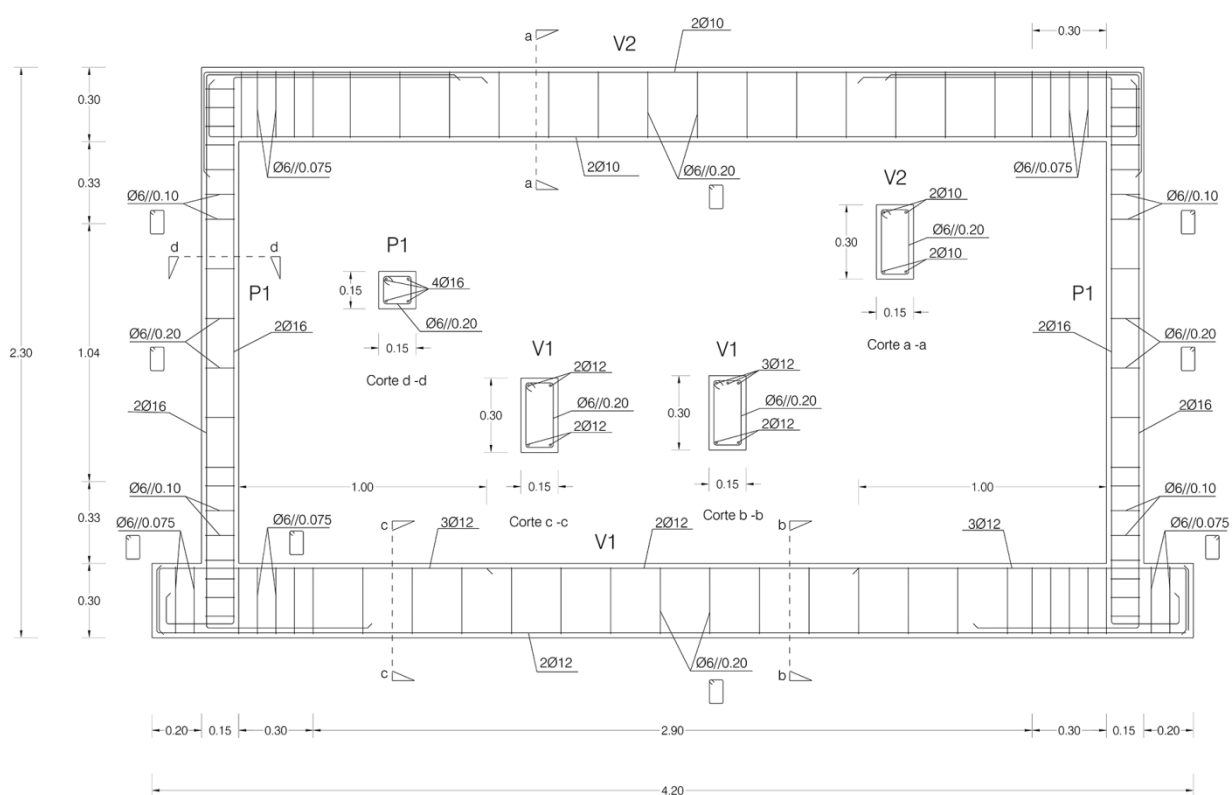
Geometria e armadura da estrutura de betão armado do painel.
